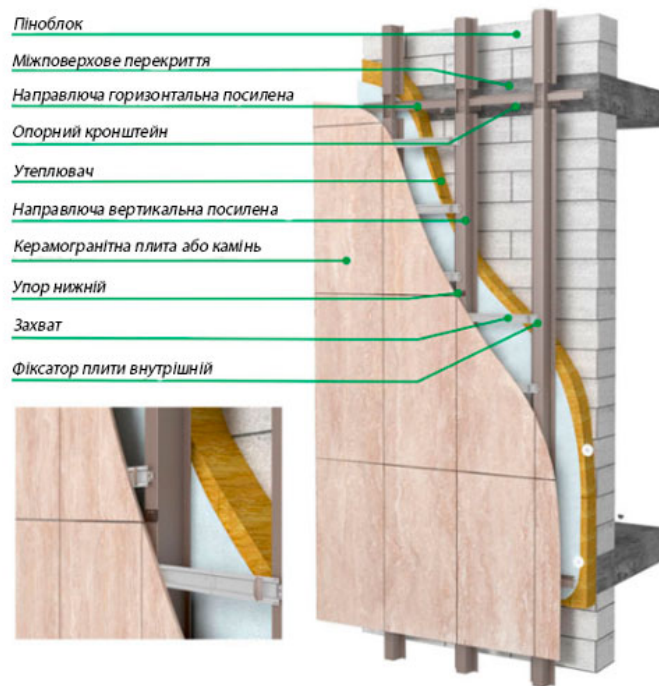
Аксонометричне зображення вентиляованого фасаду
